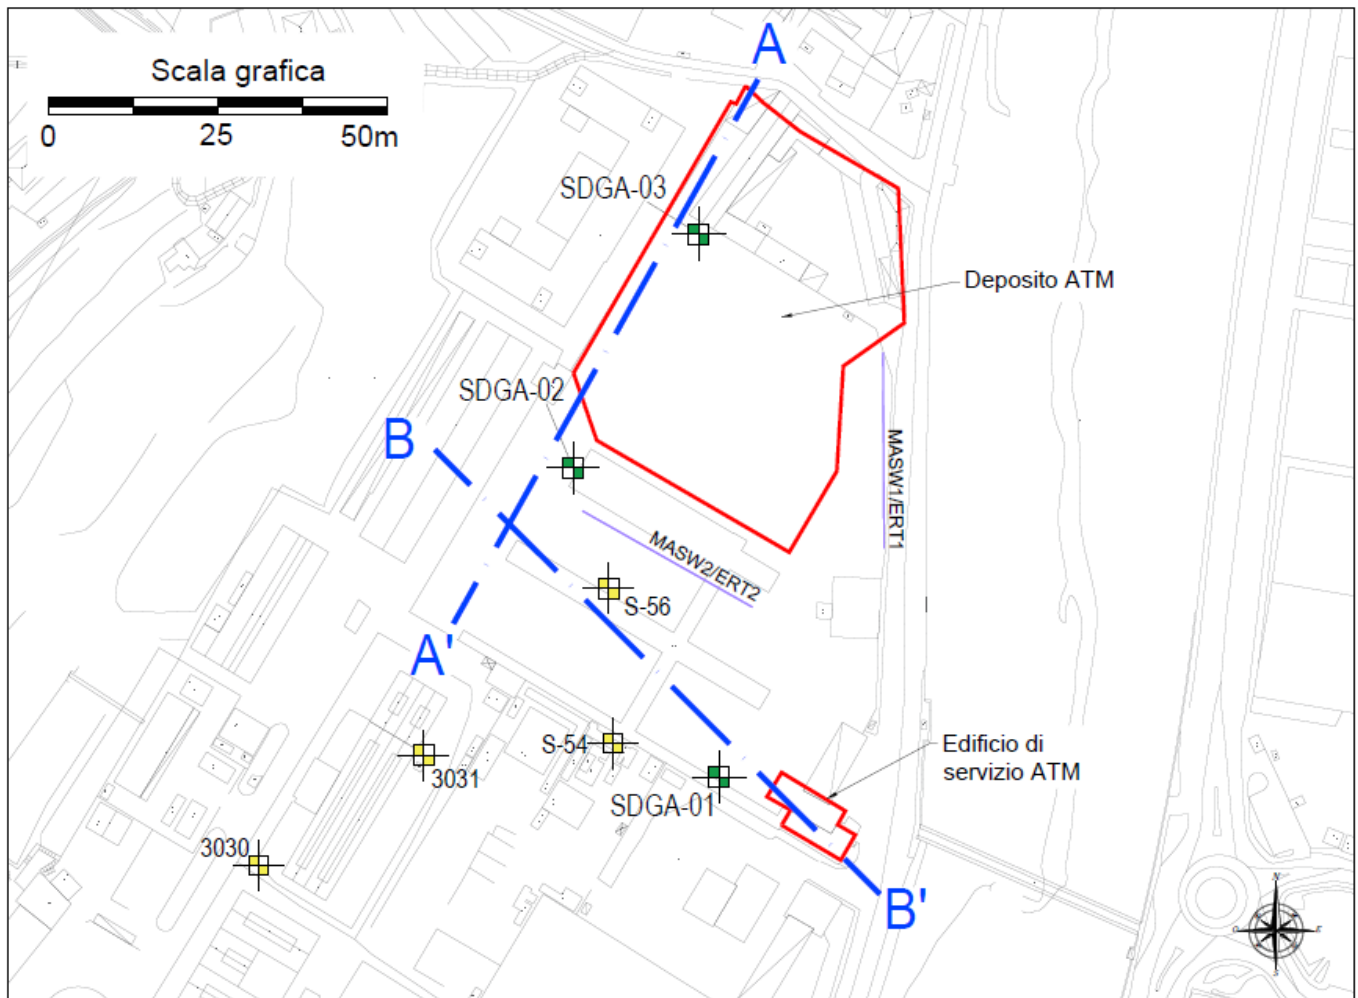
Pianta su base topografica delle indagini a disposizione, dell'ingombro dei nuovi edificati. In blu la traccia dei profili geotecnici eseguiti.
